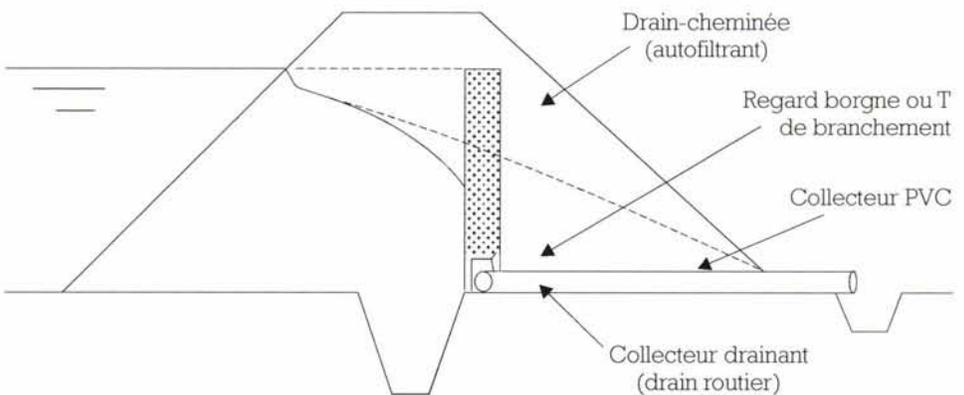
Drain vertical - rabattement de la ligne de saturation.
